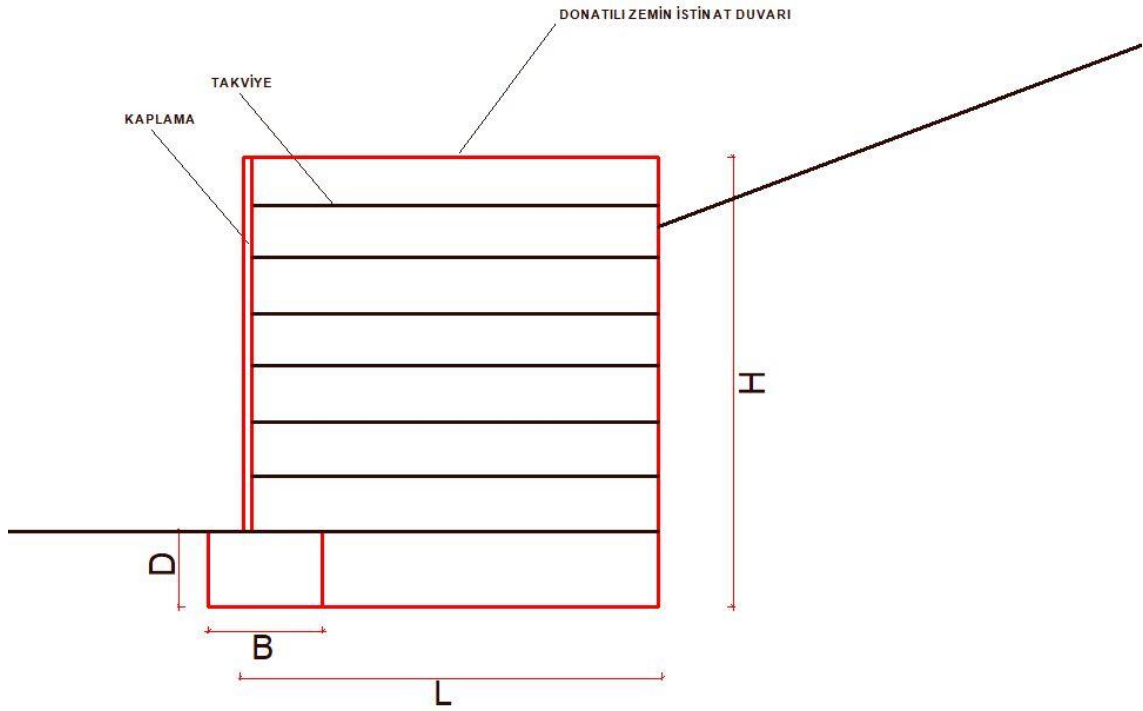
Parametrik çalışmada kullanılan geometrik modelin kesiti
